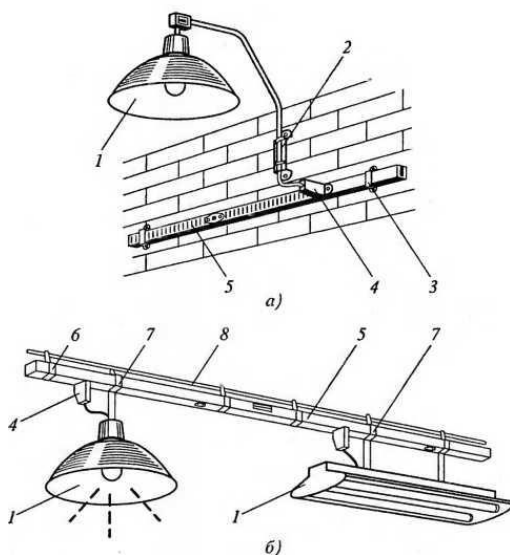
Крепление шинопровода ШОС-67 непосредственно на стене (а) и на предварительно натянутом тросе (б):
